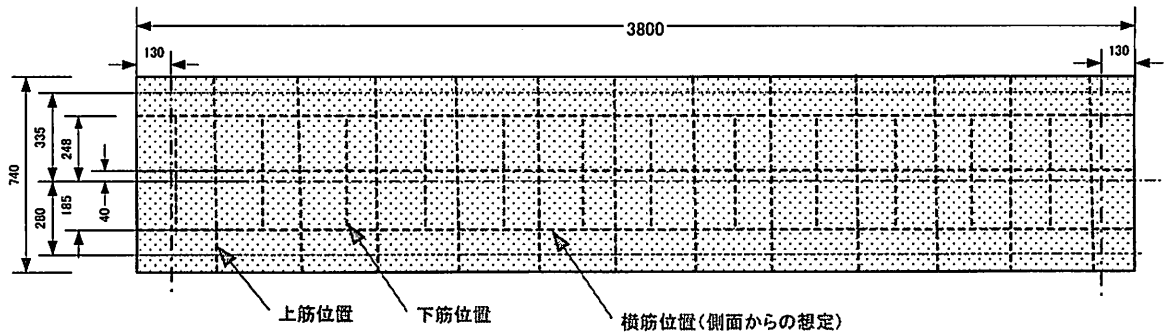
供試体① 鉄筋配置想定図(平面配置)
